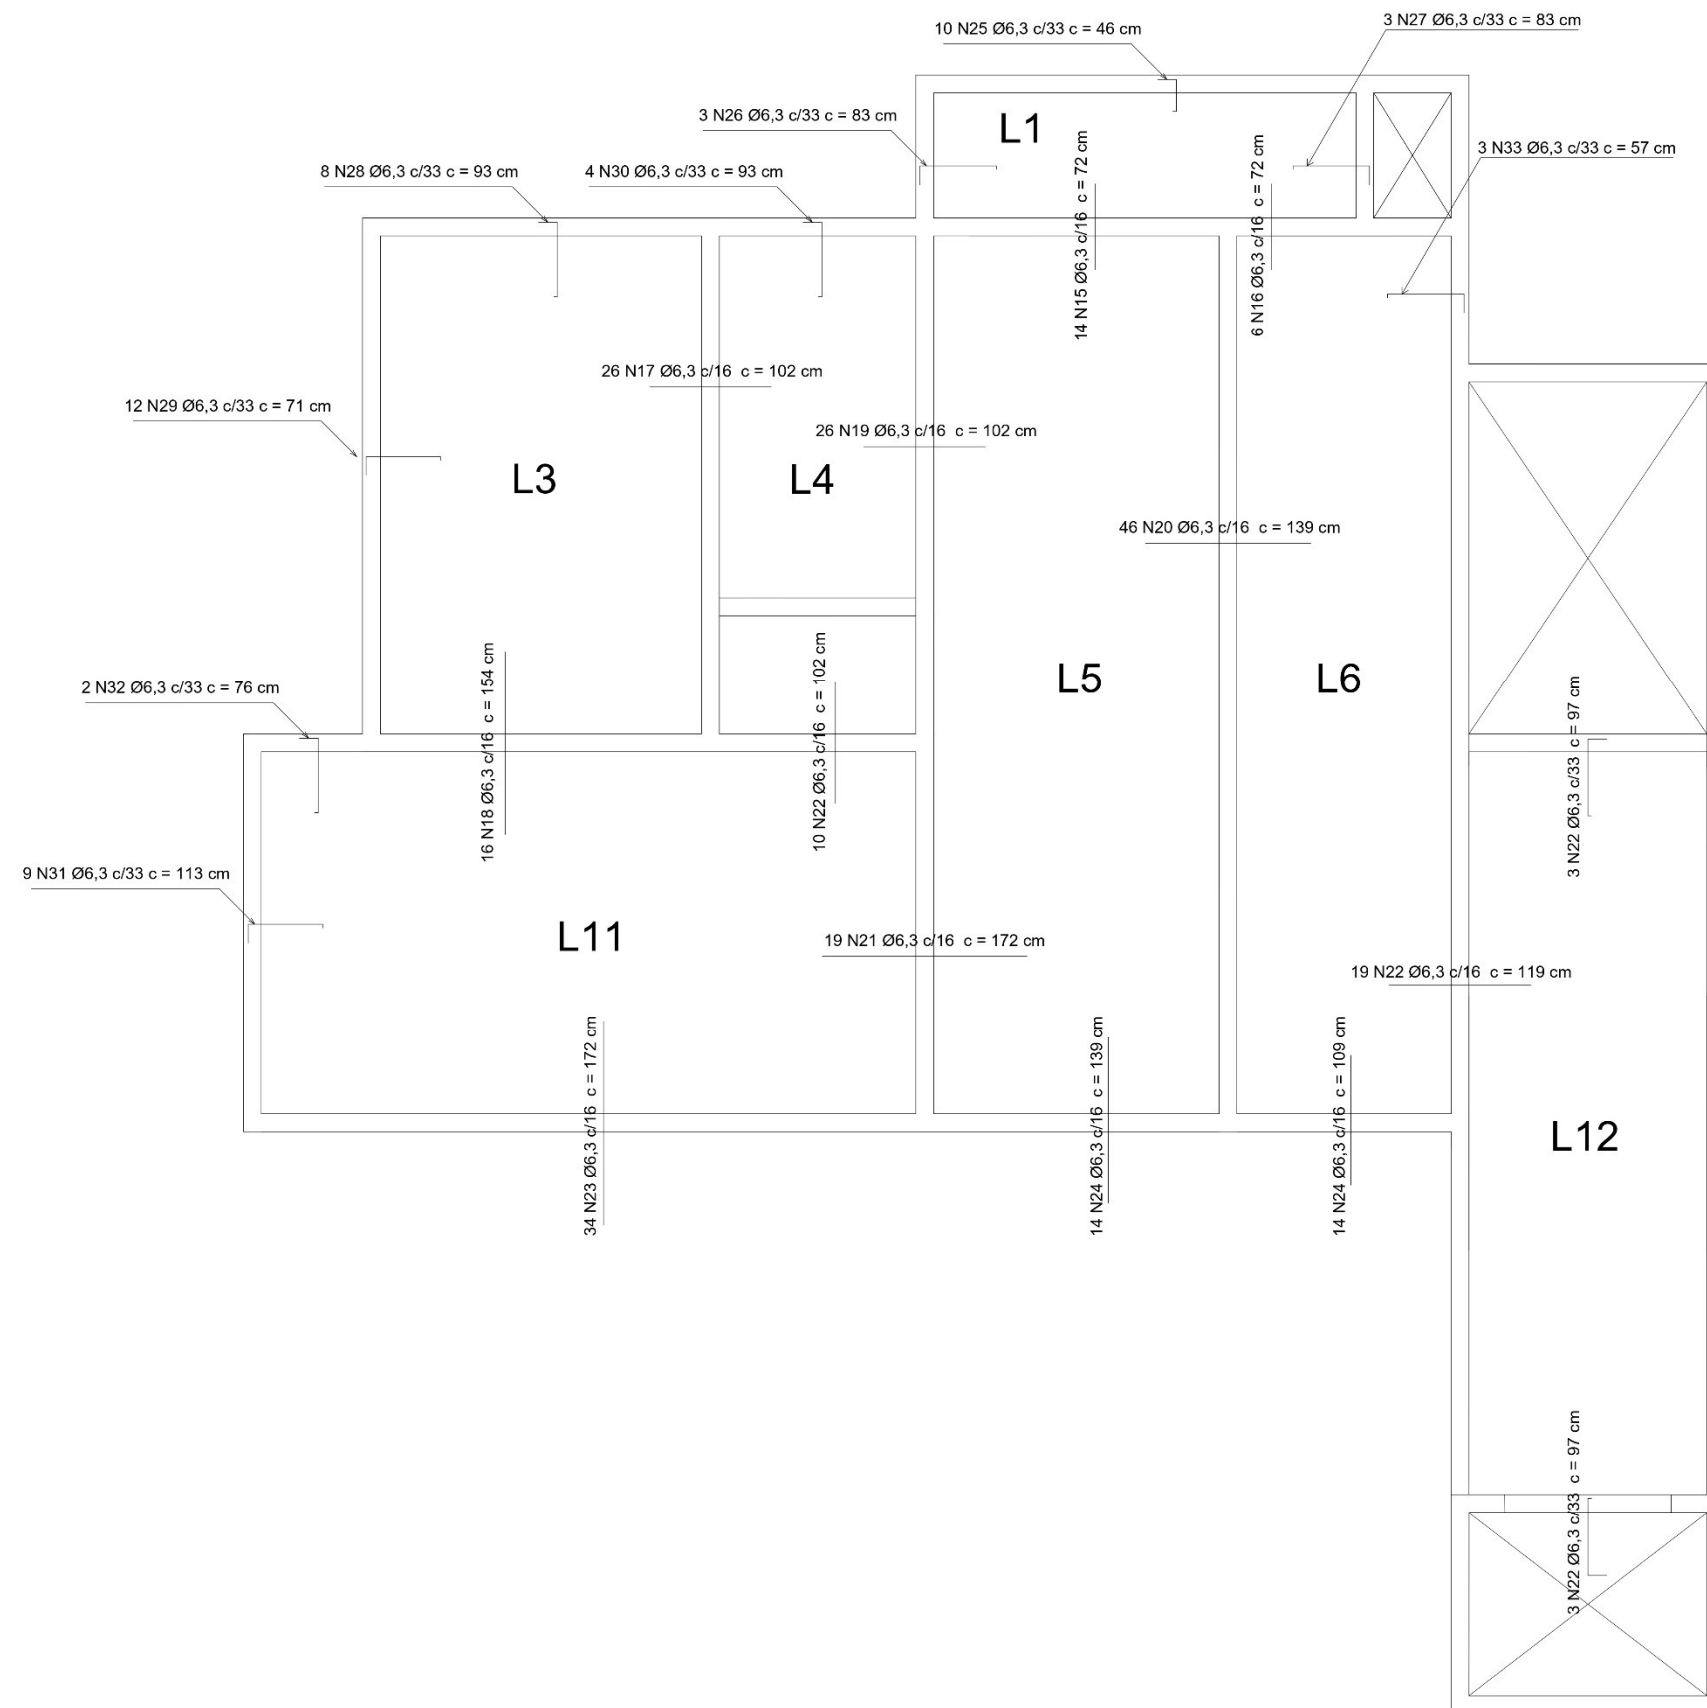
Planta de armadura negativa e de borda das lajes armadas com aço
